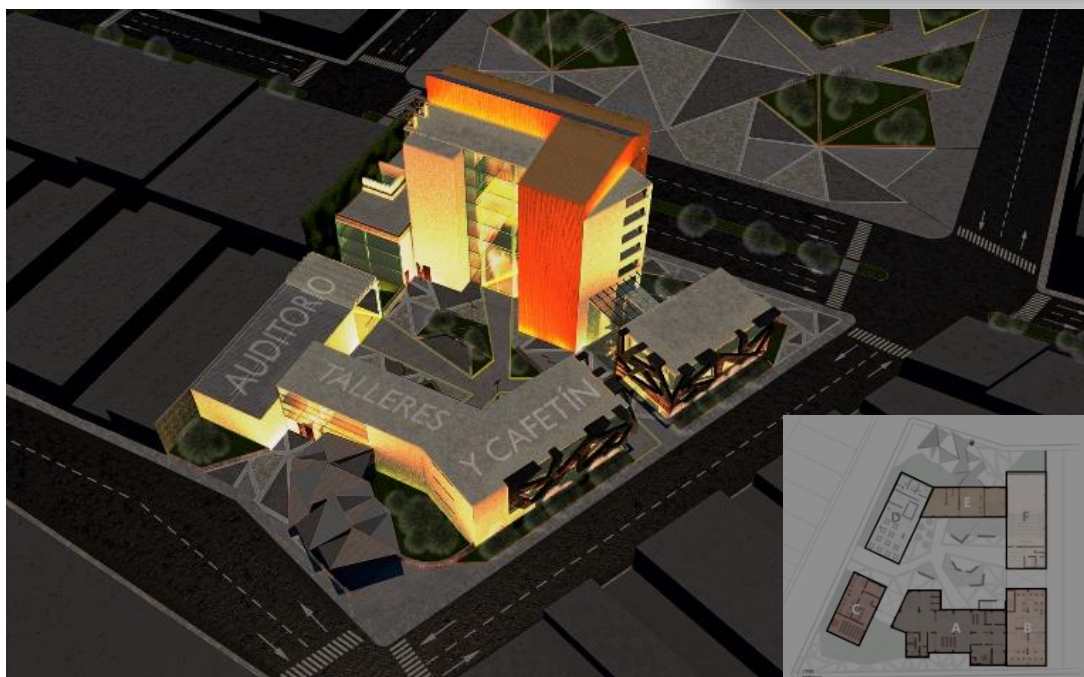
Planteamiento y Emplazamiento. - Fuente: Elaboración Propia.
